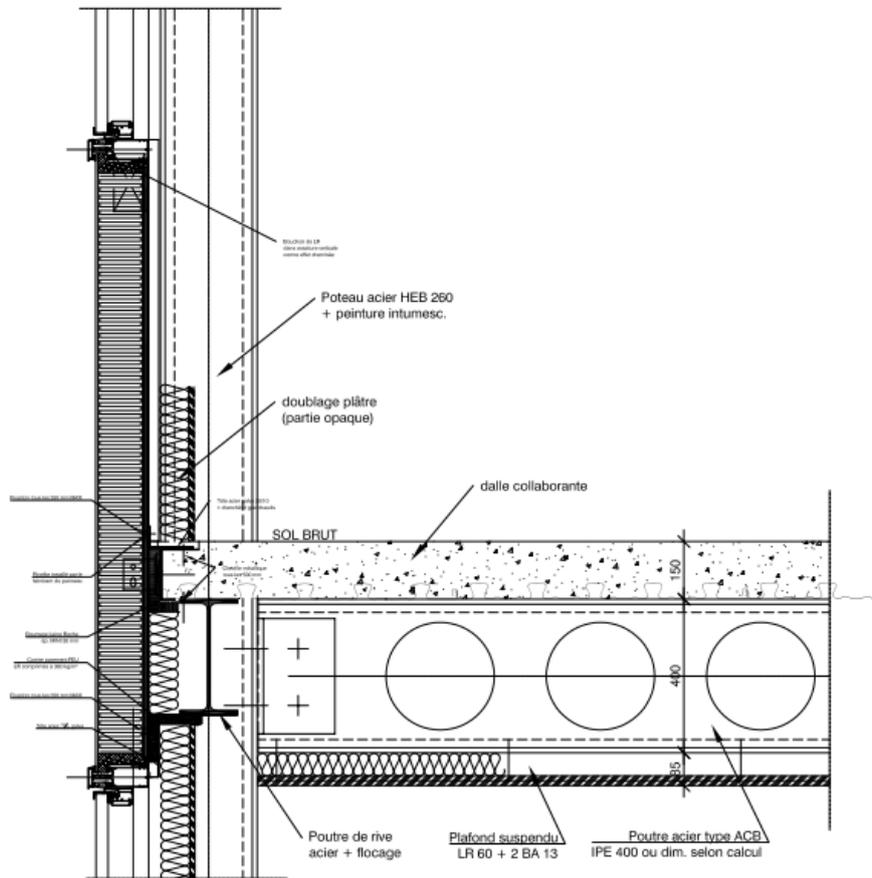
Schéma en coupe des planchers du bâtiment mixte
